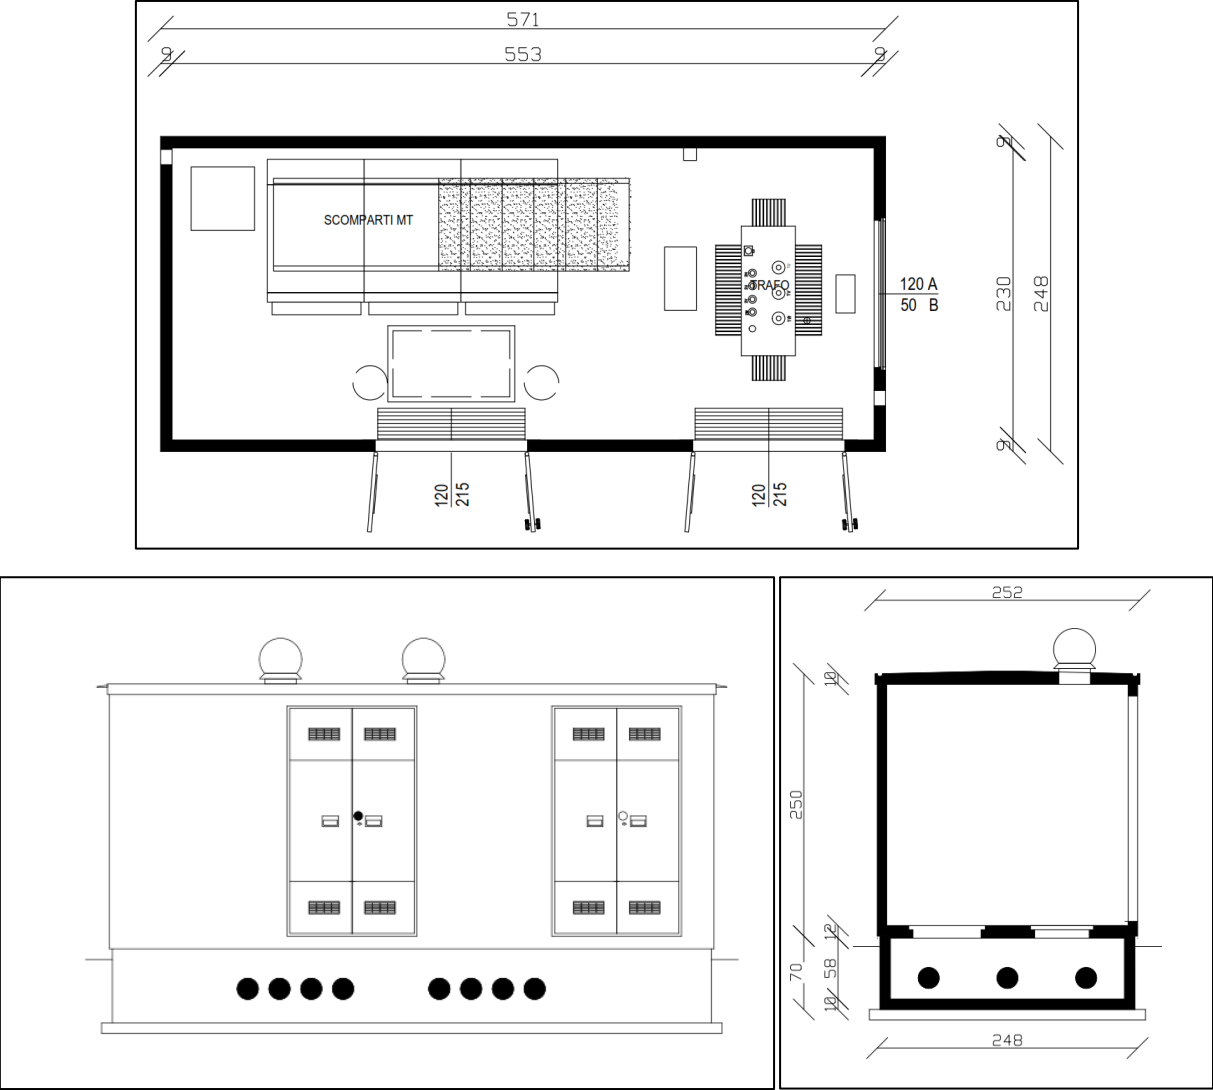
Vista in pianta/prospetto/sezione cabina di sezionamento.
